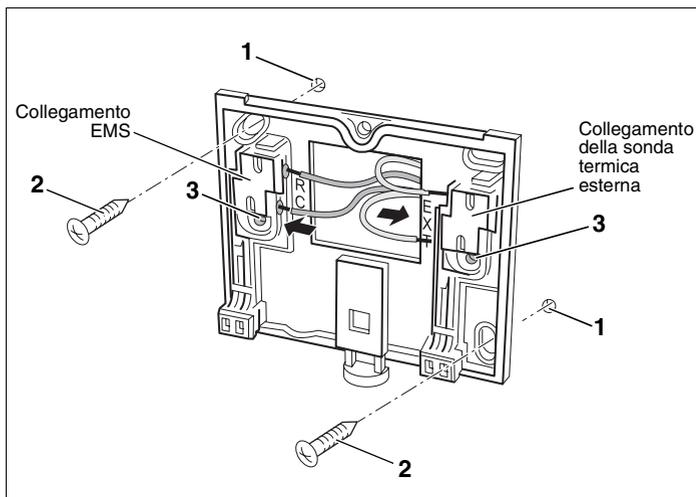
Fissaggio della piastra di montaggio sull'intonaco
